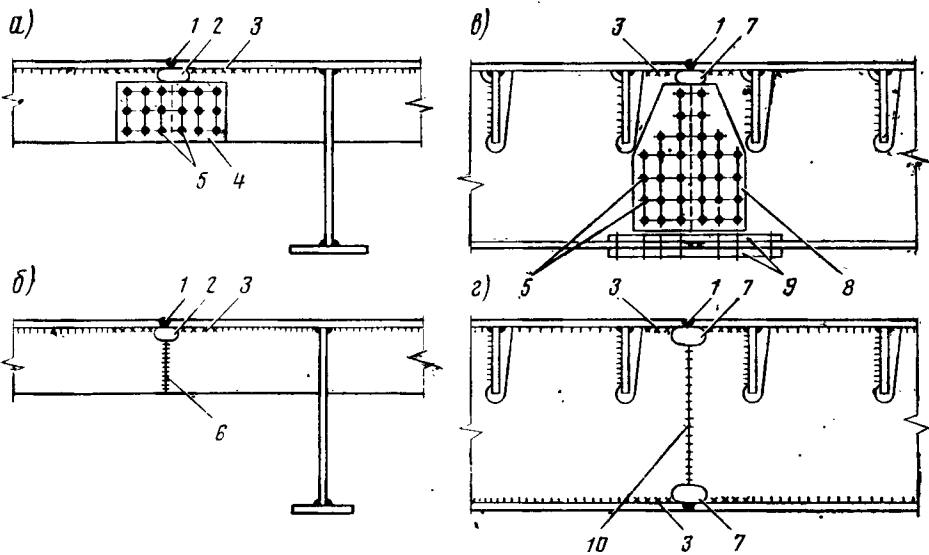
Монтажные стыки продольных ребер и поперечных балок ортотропных плит проезжей части:
